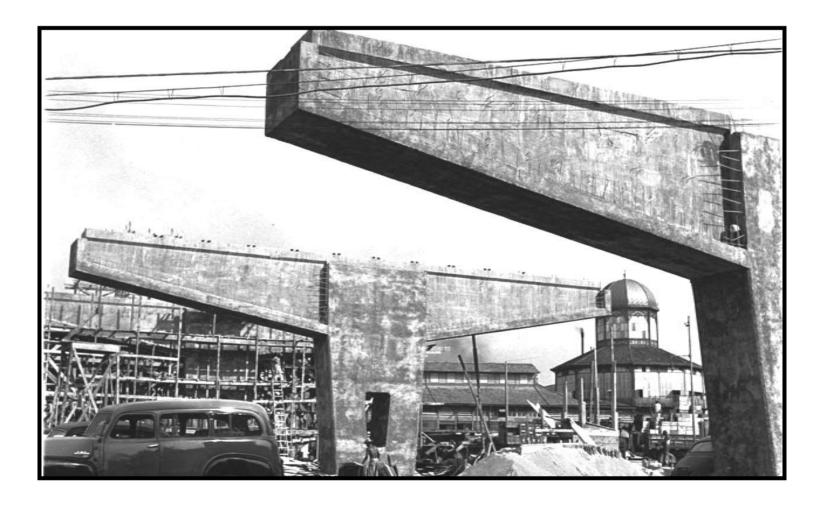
FOTO DO ELEVADO DA AV. PERIMETRAL EM CONSTRUÇÃO
